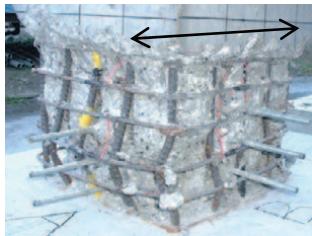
帯鉄筋、コアコンクリート及びかぶりコンクリートによる拘束のモデル化
